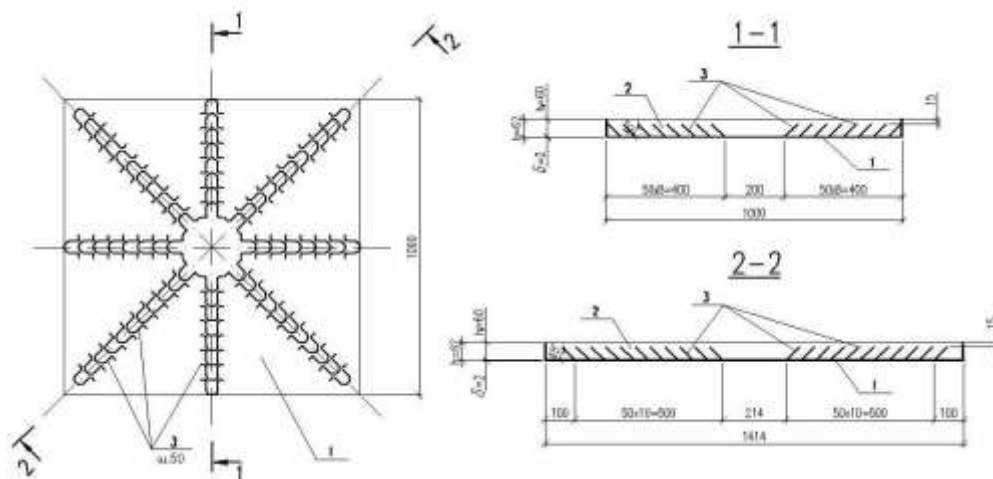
Конструкція сталобетонних плит П-3, П-4, П-7, П-8:
